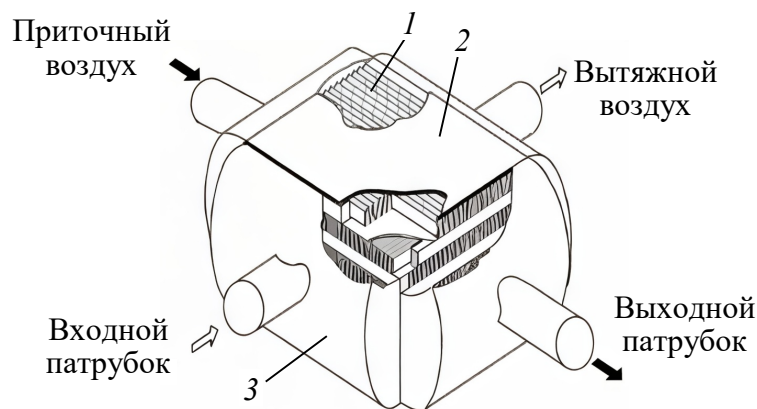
Схема перекрестно-точного утилизатора с пластинчато-ребристой поверхностью нагрева:
